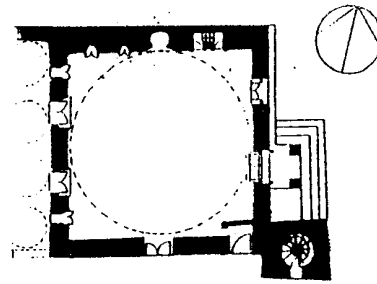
مسقط أفقى لمسجد قبة دادية
